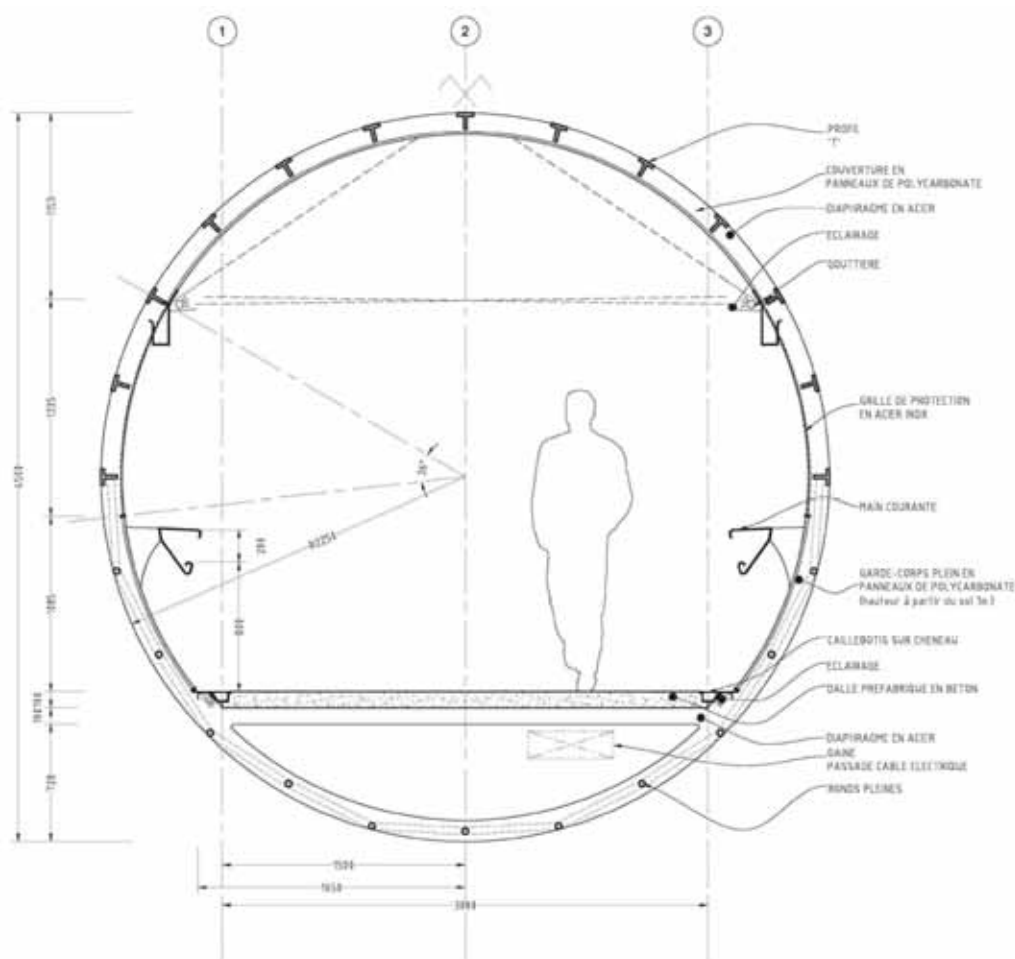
Sezione trasversale del tubo metallico con l’indicazione dell’interfaccia tra la carpenteria strutturale e gli altri componenti di finitura. (©HDA)
